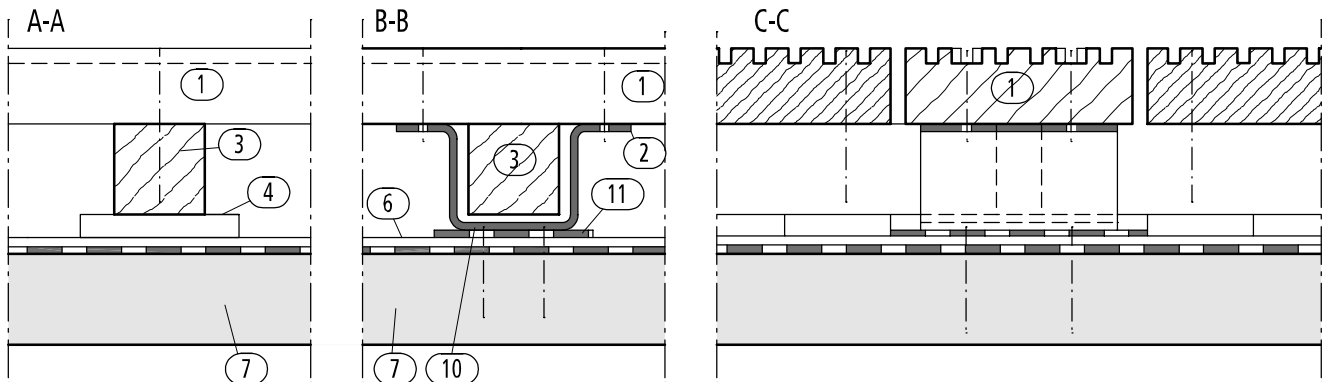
Detailausbildung des Auflagers eines Bohlenrostes mit gekanteten Blechen als Einfassung für die Längslattung des Rostes
